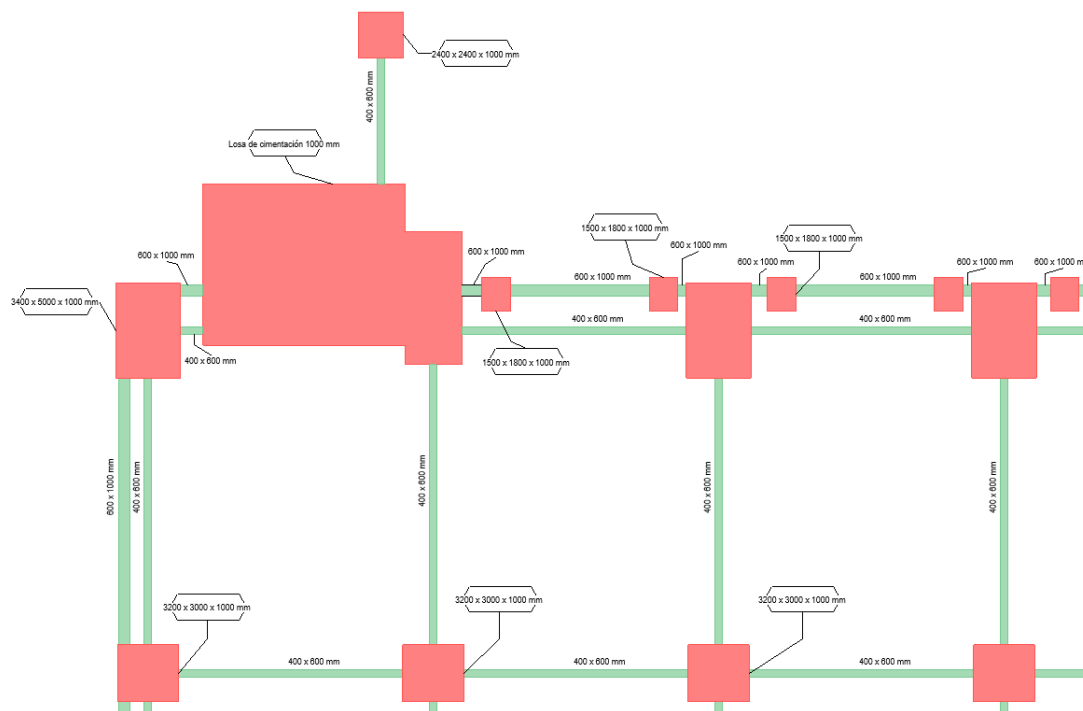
Vista de planta de la cimentación en la zona de la losa 1.
